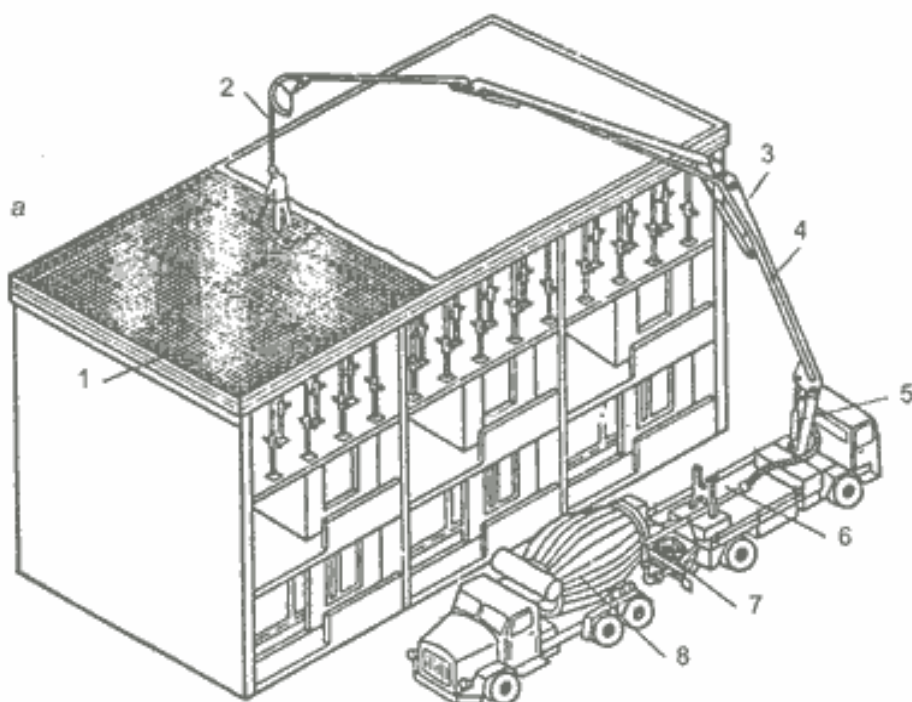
Укладка бетонной смеси автобетононасосами:
